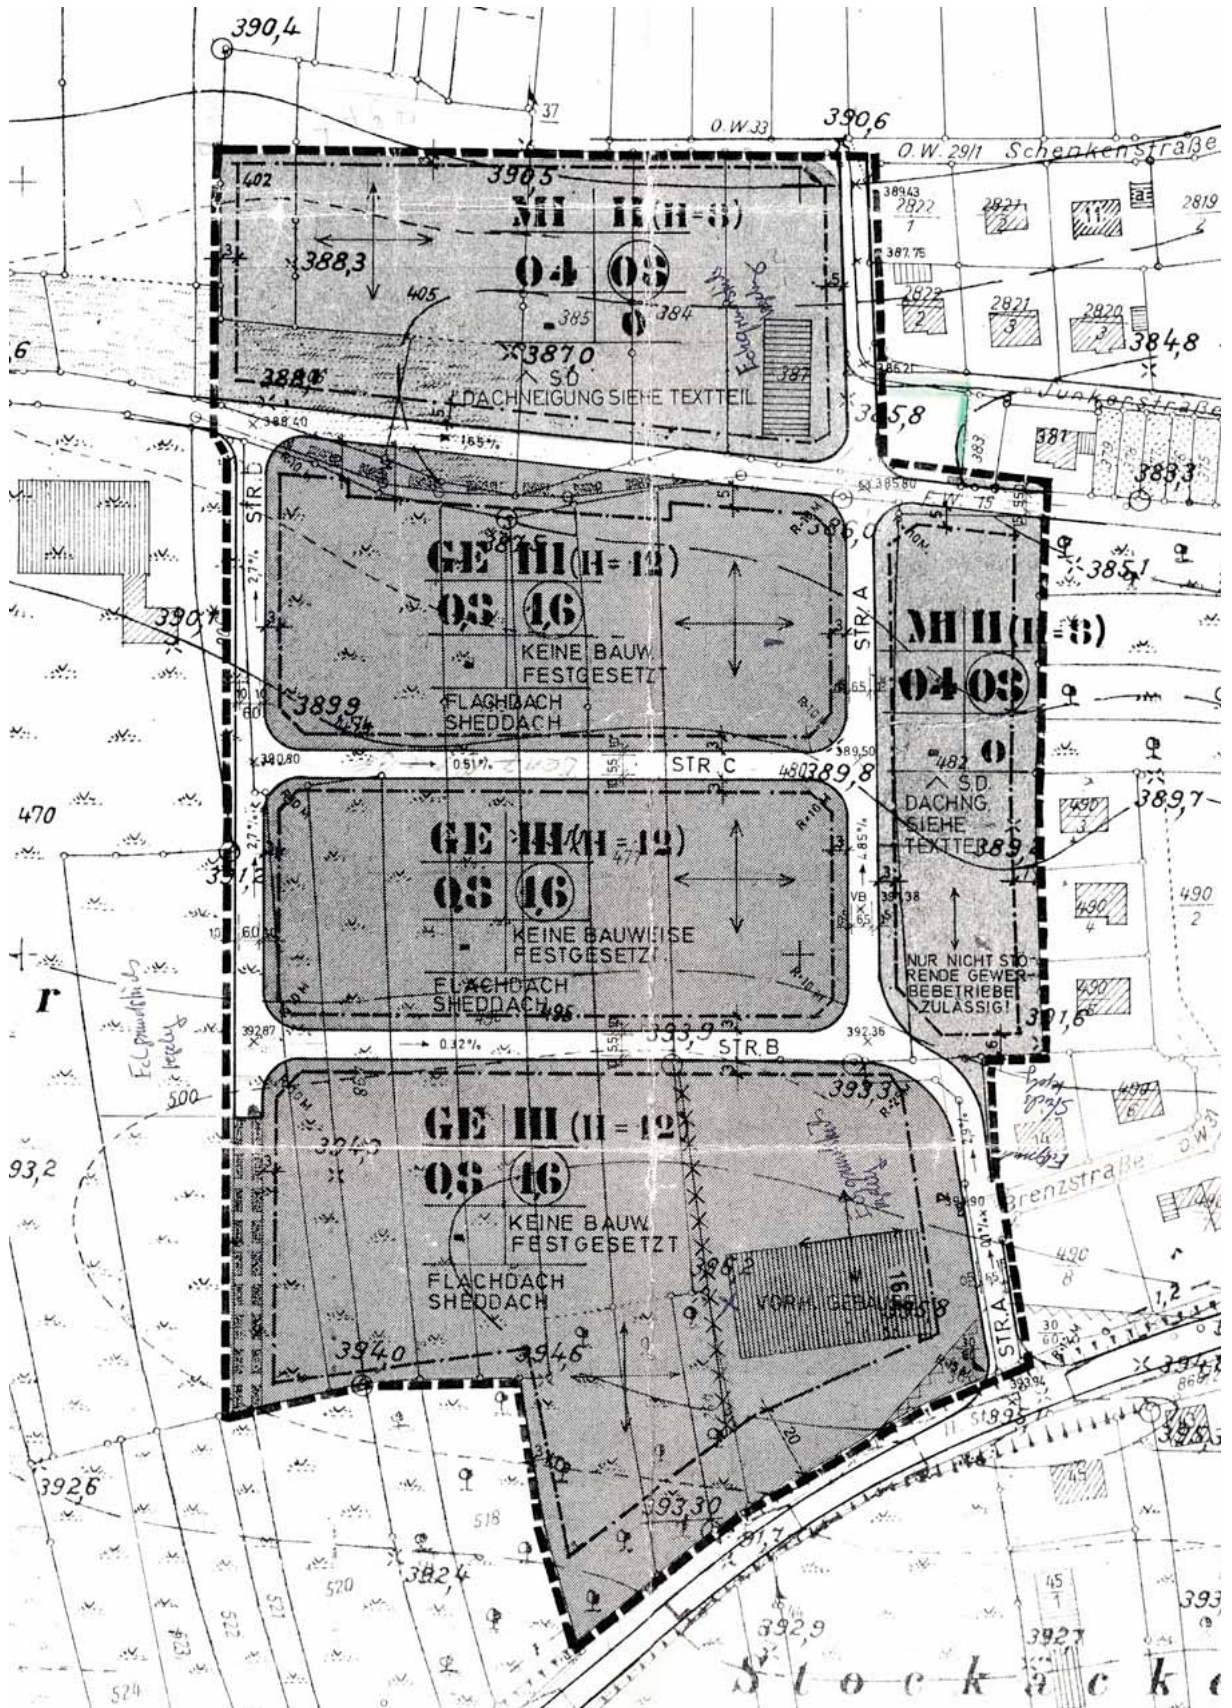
Bebauungsplan „Häcker“, ohne Maßstab
